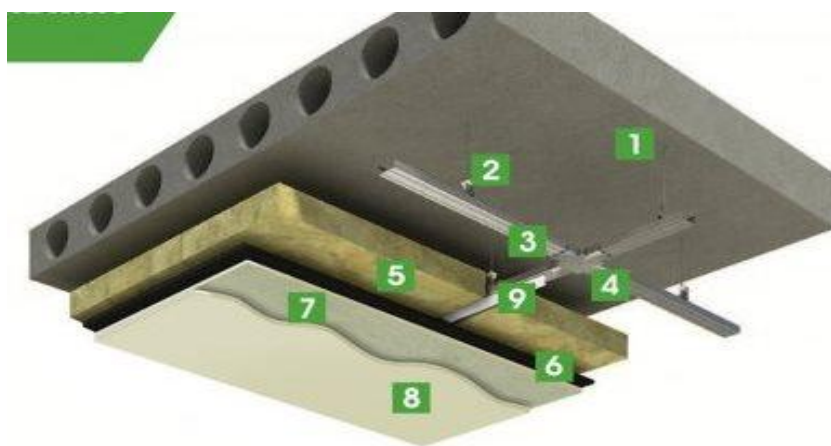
Схема акустической изоляции потолка с железобетонными перекрытиями
